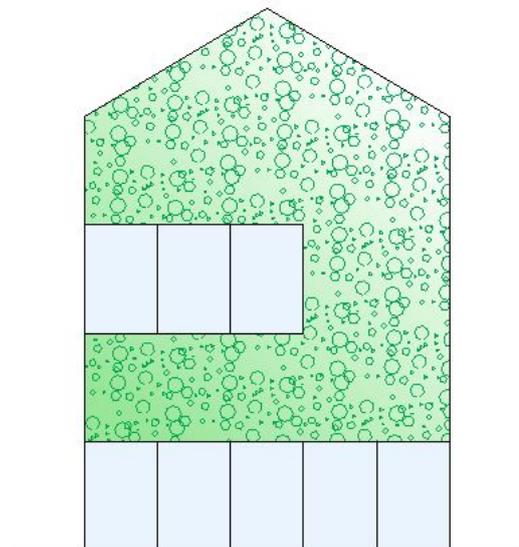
Fassade mit einer flächigen Konstruktion zur Begrünung
